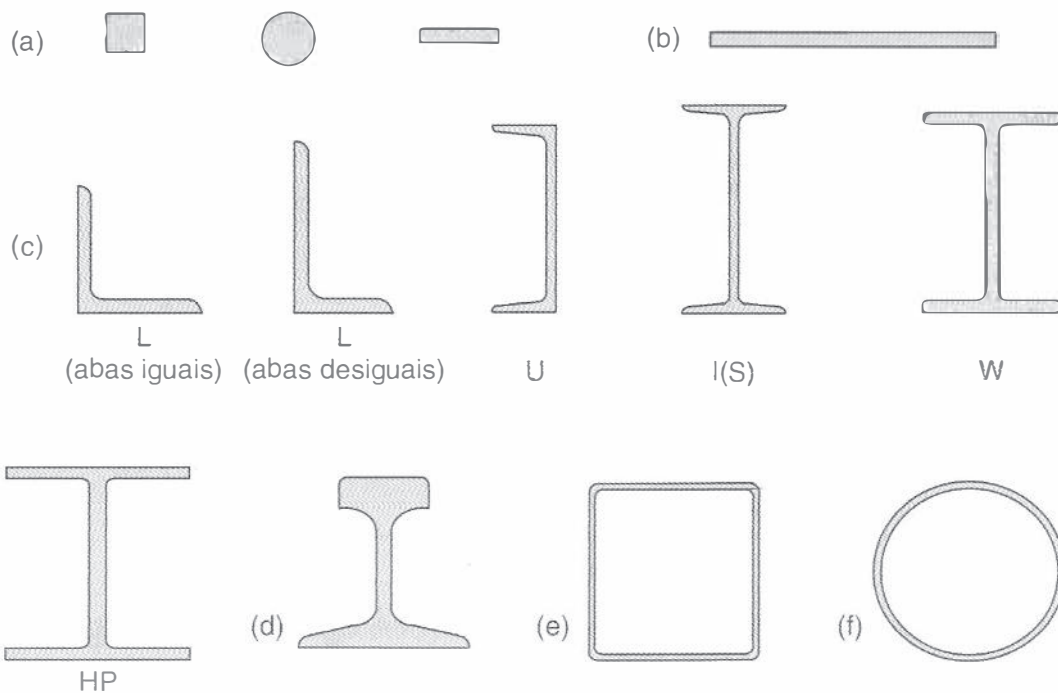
Principais tipos de produtos siderúrgicos laminados de utilização estrutural: (a) barras, com diversas seções transversais (quadrada, redonda, chata); (b) chapas; (c) perfis estruturais laminados; (d) trilho; (e) tubo quadrado; (f) tubo redondo.
